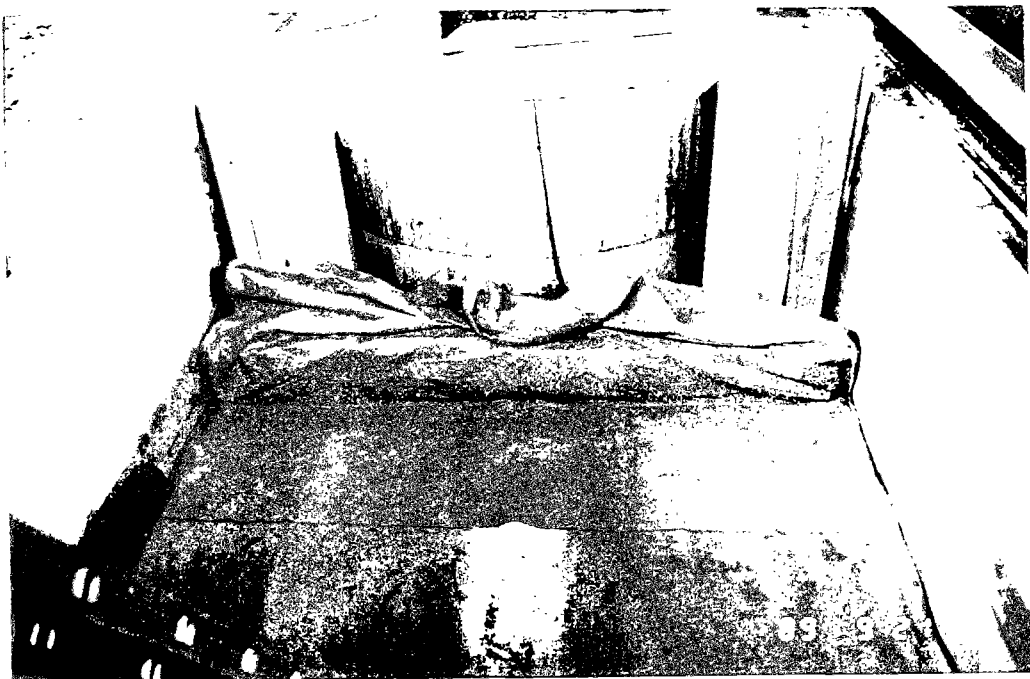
Construction du mur expérimental : mise en place du retour de la nappe de renforcement
